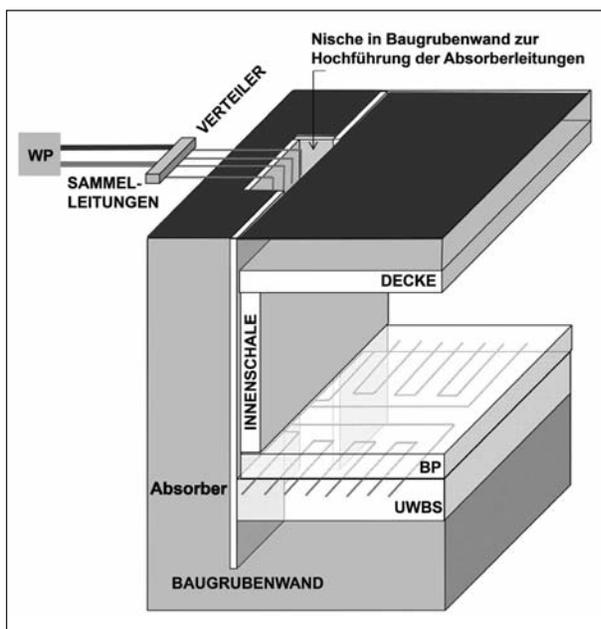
Beispielhafter Aufbau einer Tunnelthermie-Anlage bei einem in offener Bauweise errichteten Tunnelbauwerk (offene Baugrube mit temporären Baugrubenwänden) mit Energiebodenplatte. Die Absorberleitungen werden dabei auf der Unterwasserbetonsohle (oder einer Sauberkeitsschicht) verlegt. Sollen die Absorberleitungen nicht ins Tunnelinnere geführt werden, so können diese beispielsweise in einer Nische der Baugrubenwand seitlich des Bauwerkes hochgeführt und an den Verteiler angeschlossen werden (z. B. in einem Betriebsraum oder einem Schacht situiert)
